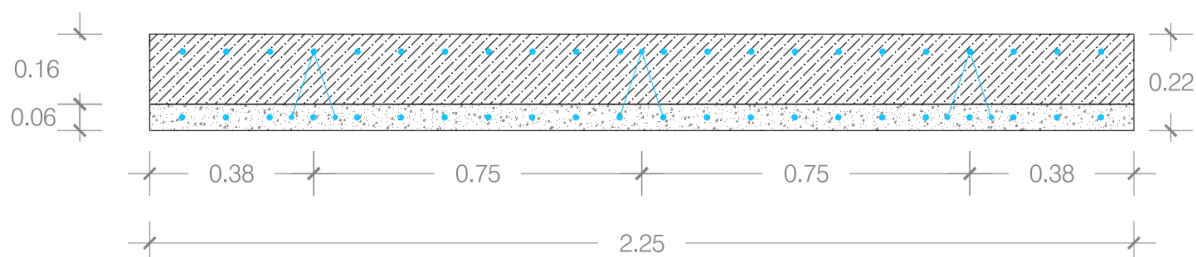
Solução da pré-laje maciça de vão extremo
